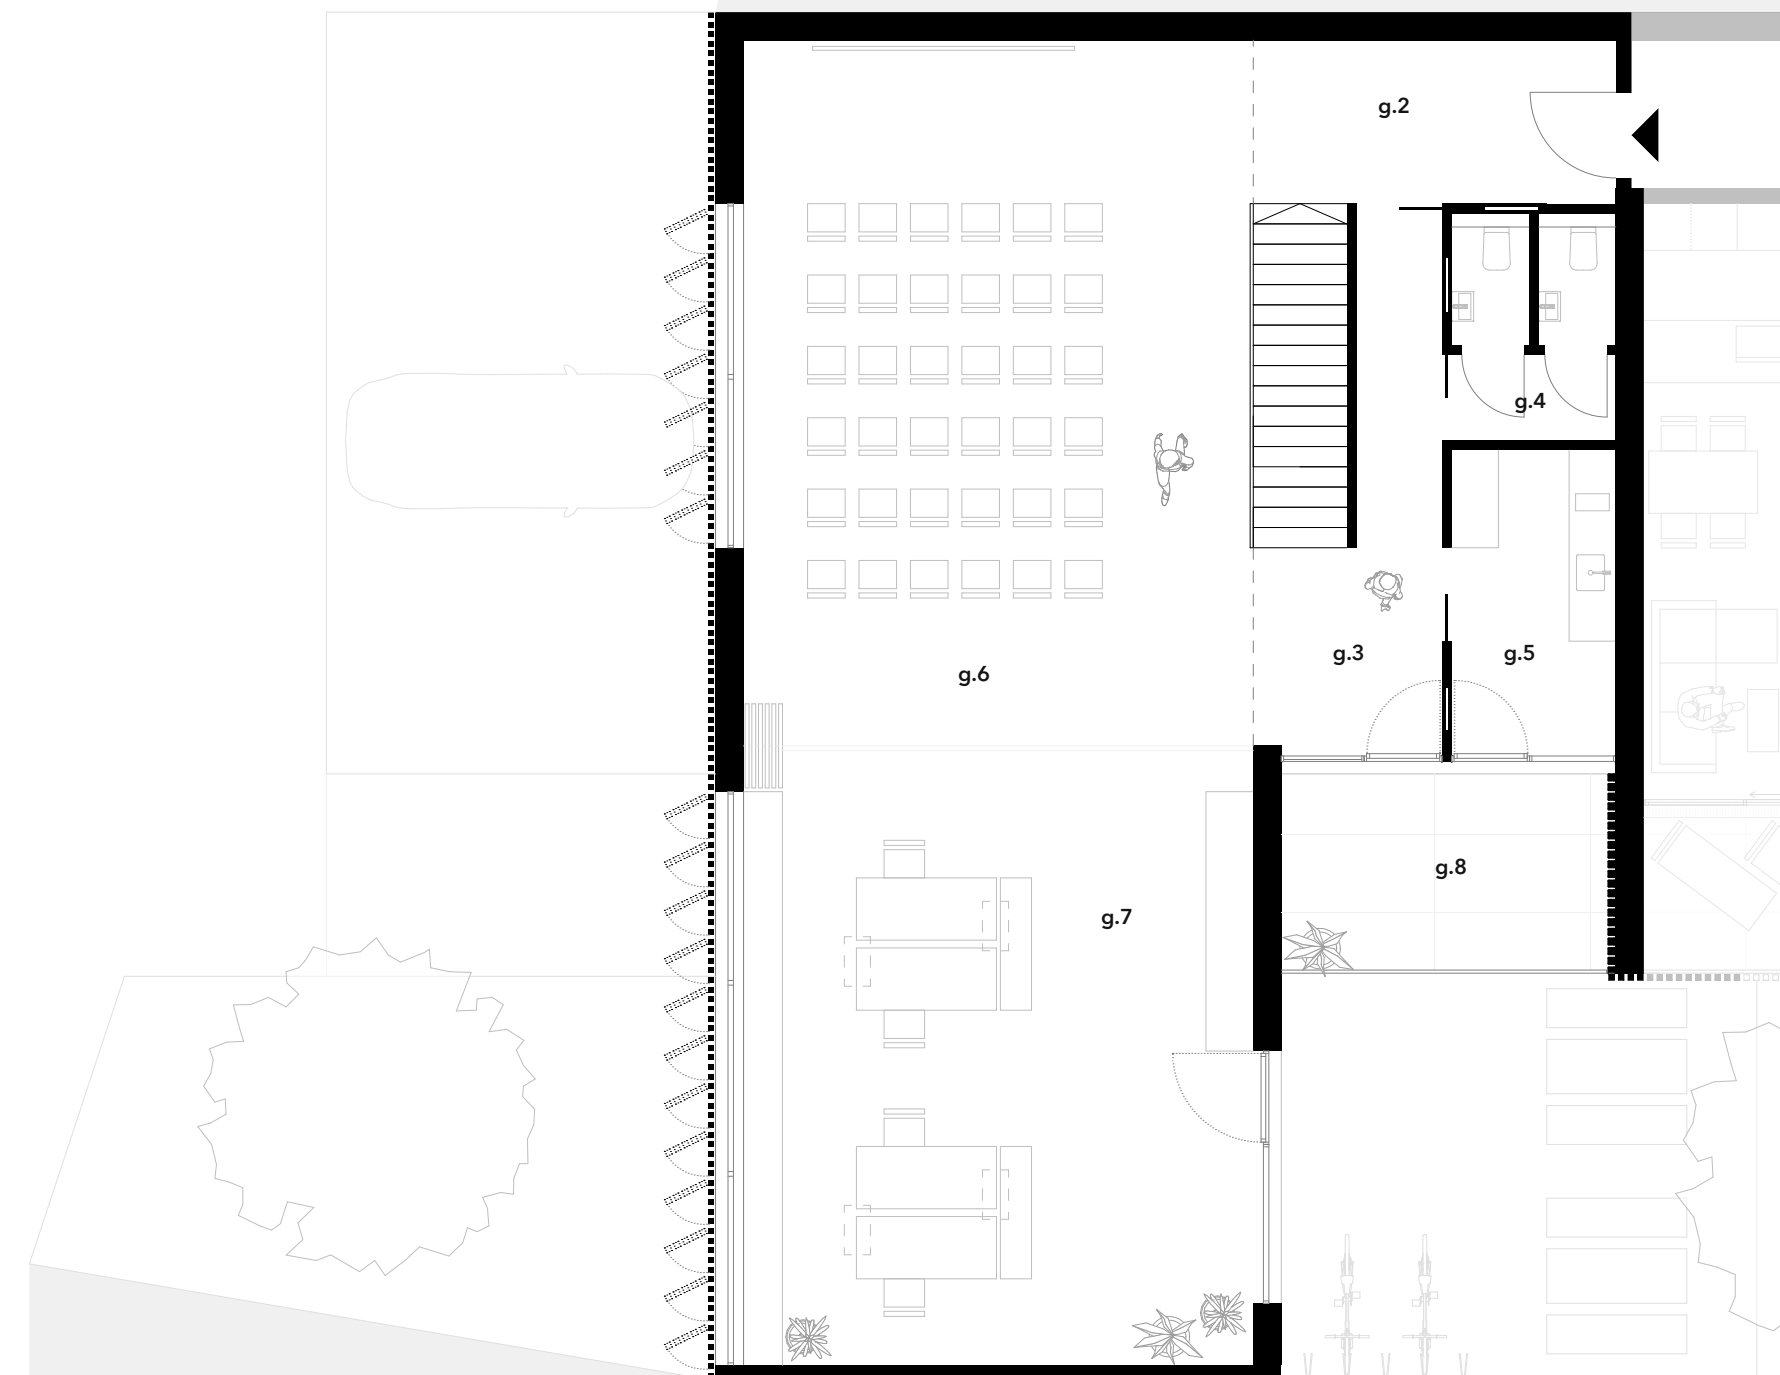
Grundriss Gemeindeamt OG
